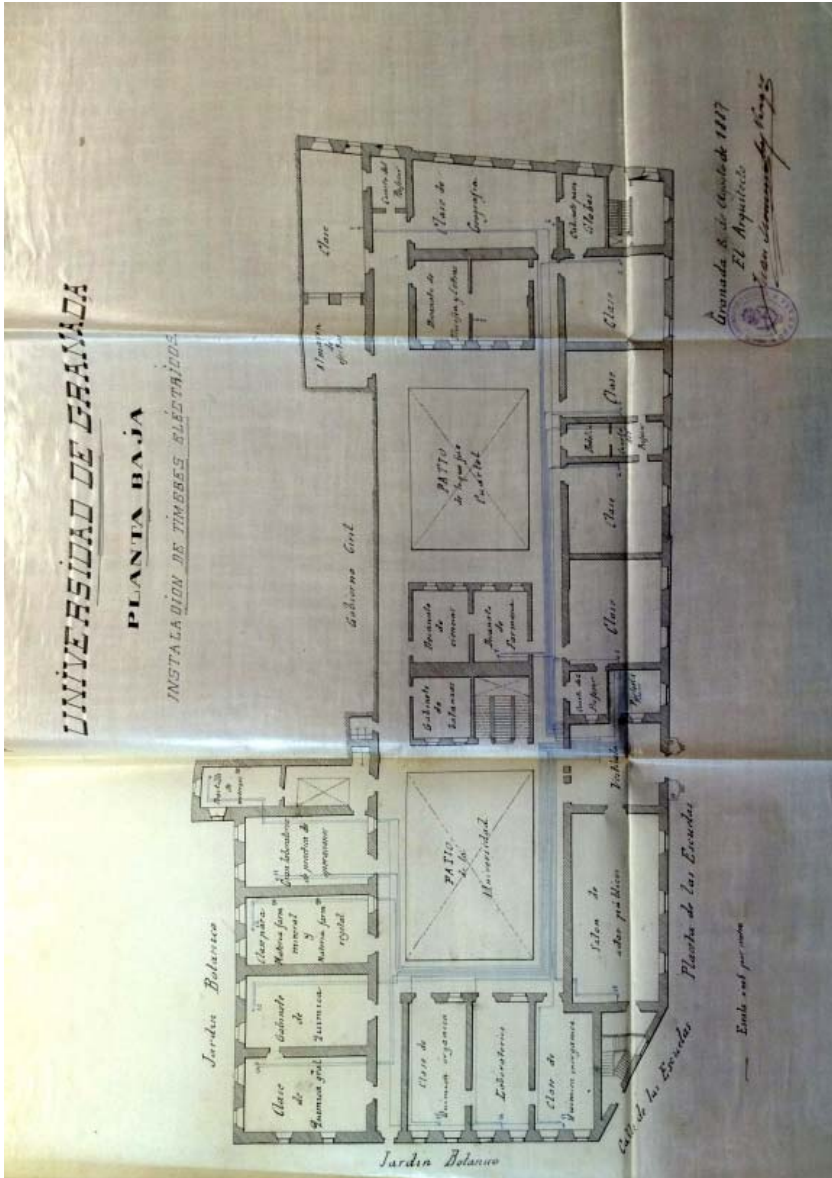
Plano de la Universidad para la instalación de timbre eléctrico con distribución de espacios. Planta baja. 1884. Archivo de la Diputación Provincial, 1884.
